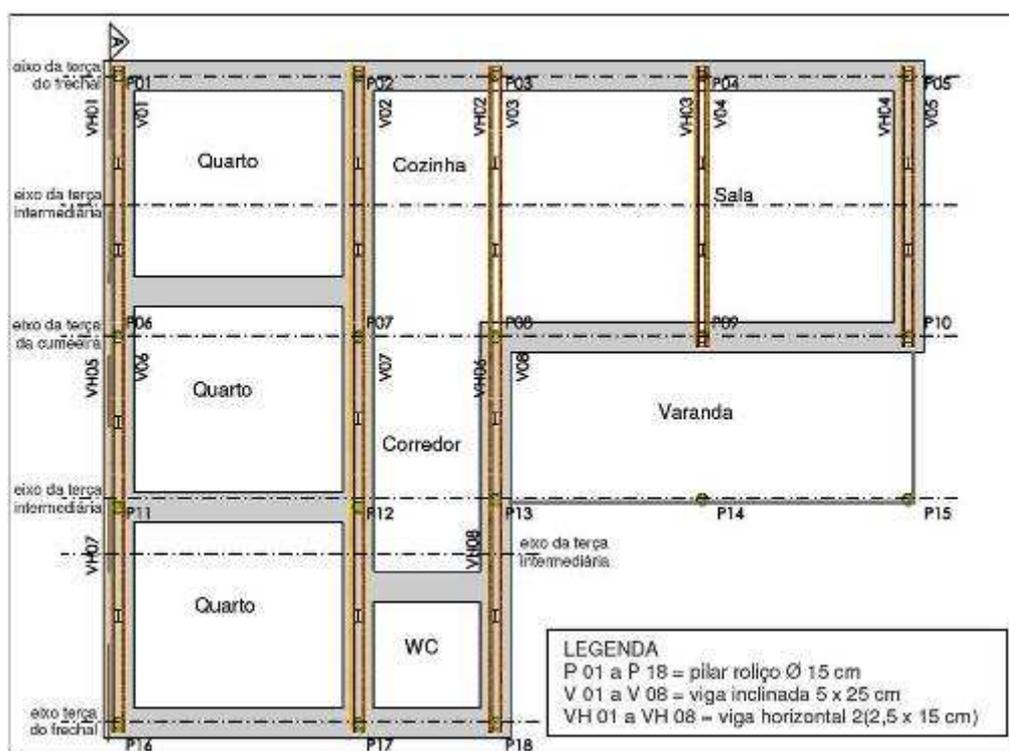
Planta da casa no sistema estrutural pilar-viga e vedação com adobes (acervo HABIS).
